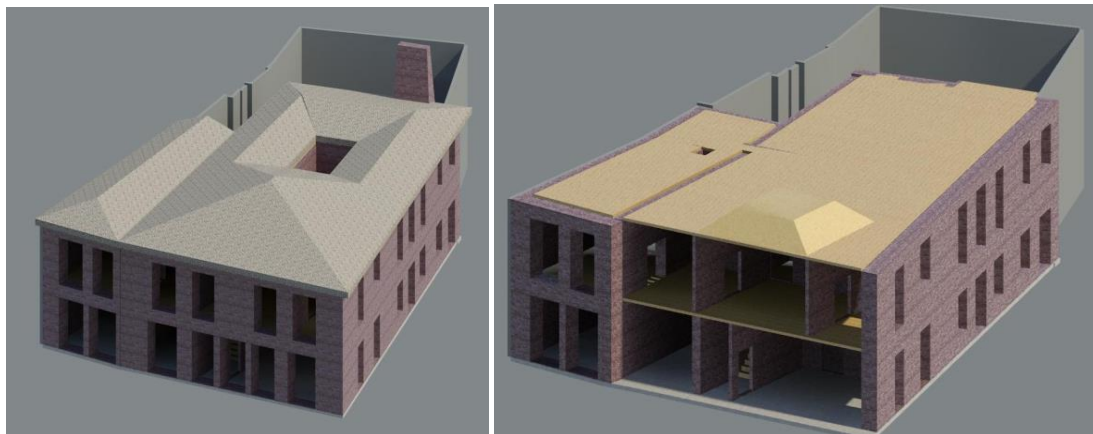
Imagens do modelo BIM 3D fase de levantamento do edifício existente.
